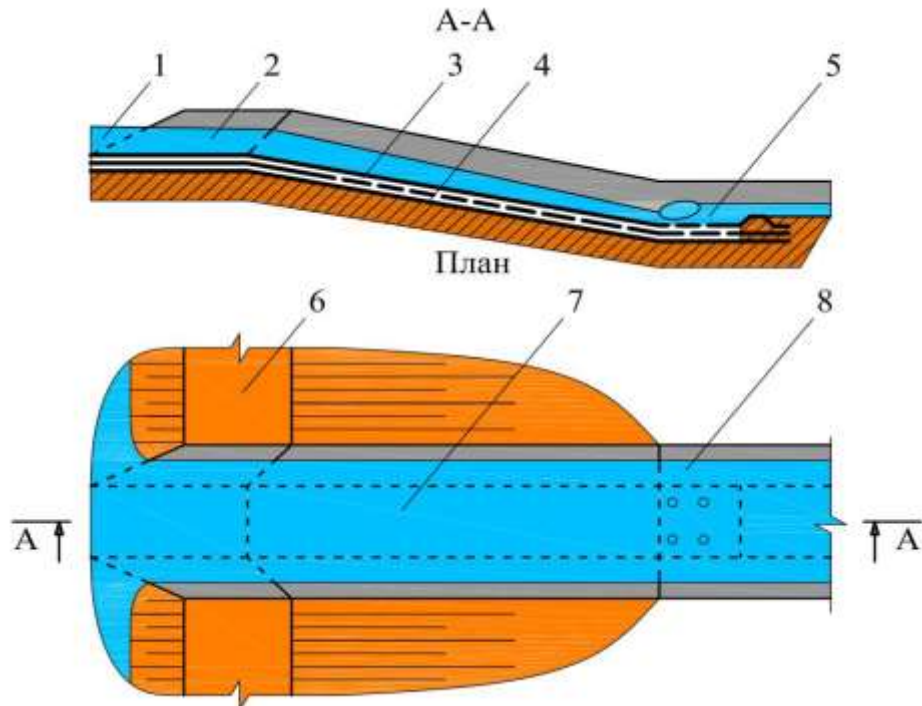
Схема лотка быстротока [29]: 1 – входная часть; 2 – водосливная часть; 3 – двойное полотнище из геомембраны; 4 – дренирующий слой из геотекстиля; 5 – водобойный колодец; 6 – грунтовая плотина; 7 – быстроточная часть; 8 – отводящее русло
